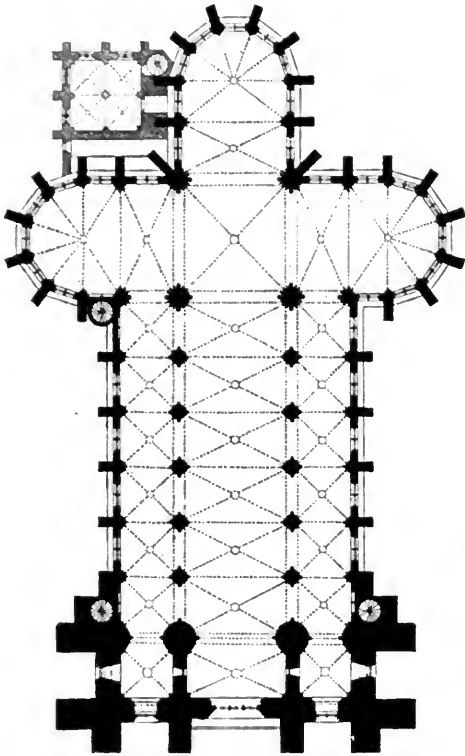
Grundriß der St. Elisabethkirche zu Marburg.
